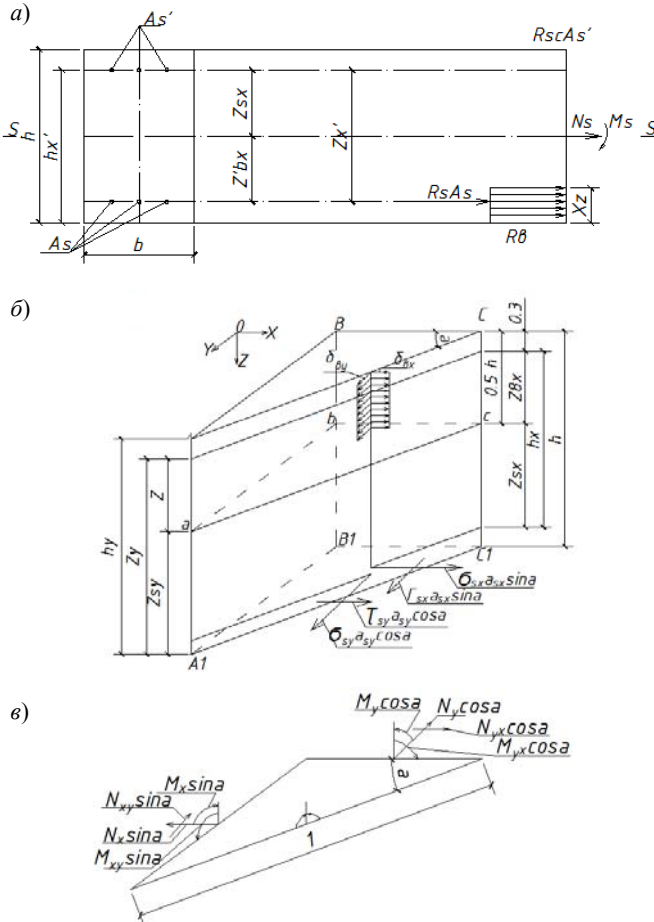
Определение напряжений в арматуре и бетоне на площадке косої трещины:
